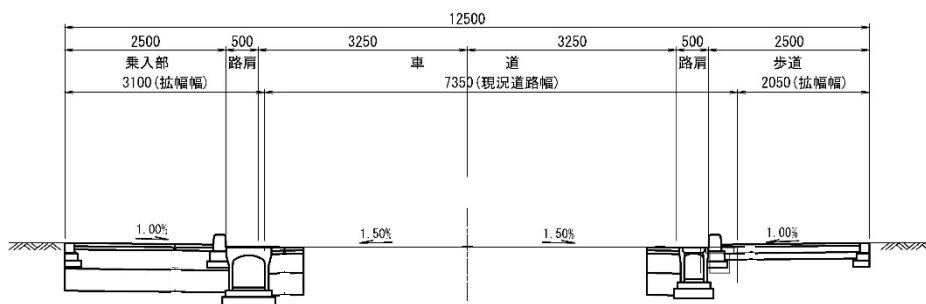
(6) 標準断面図 (主要地方道行田・蓮田線 (拡幅部) 幅員 12.5m)
